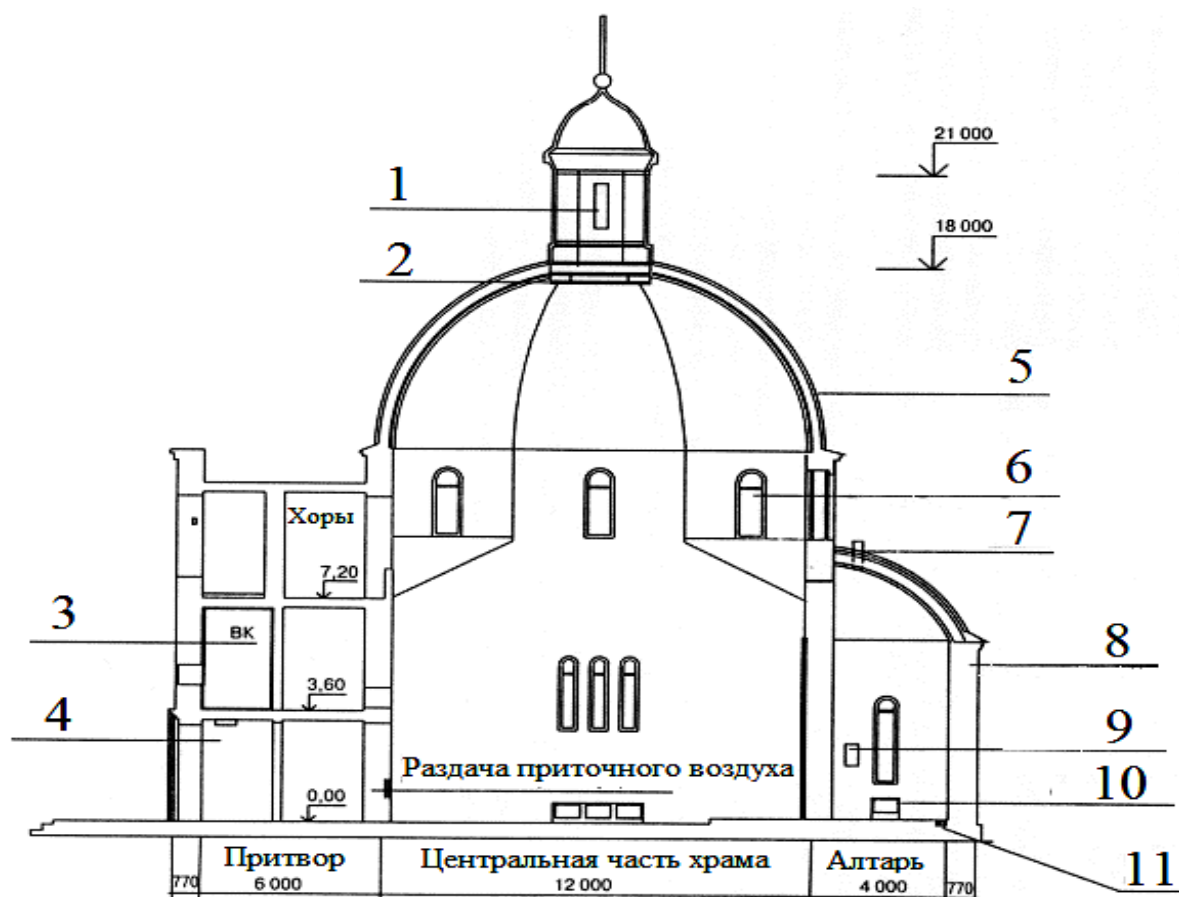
Схема православного храма вместимостью 300 человек: 1 – глухой «барабан» с вытяжными отверстиями, оборудованными заслонками с электроприводом или аэрационными устройствами, 2 – вытяжная решетка, 3 – вентиляционный канал, 4 – воздушная или тепловоздушная завеса на входе в храм, 5 – купол и конха апсиды (каркасная конструкция с утеплителем), 6 – оконные проемы в верхней зоне храма с вытяжными фрамугами, 7 – вытяжная шахта с утепленным клапаном с ручным или дистанционным управлением, 8 – наружные стены с тепло – и пароизоляцией, 9 – местная вытяжка в зоне розжига угля и подвески кадила, 10 – отопительные приборы, 11 – нижняя разводка труб водяного отопления в каналах, закрытых решетками
